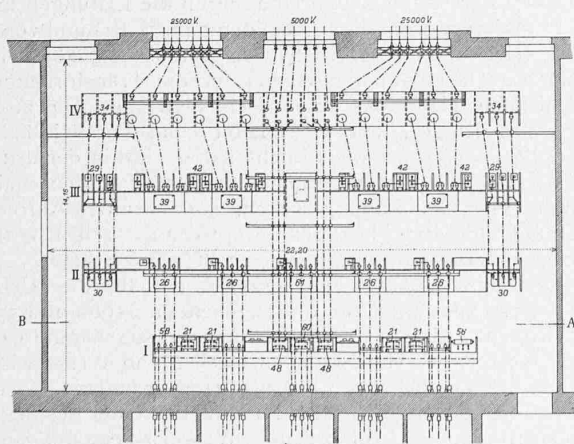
Grundriss des Apparatenraumes. — 1 : 300.
